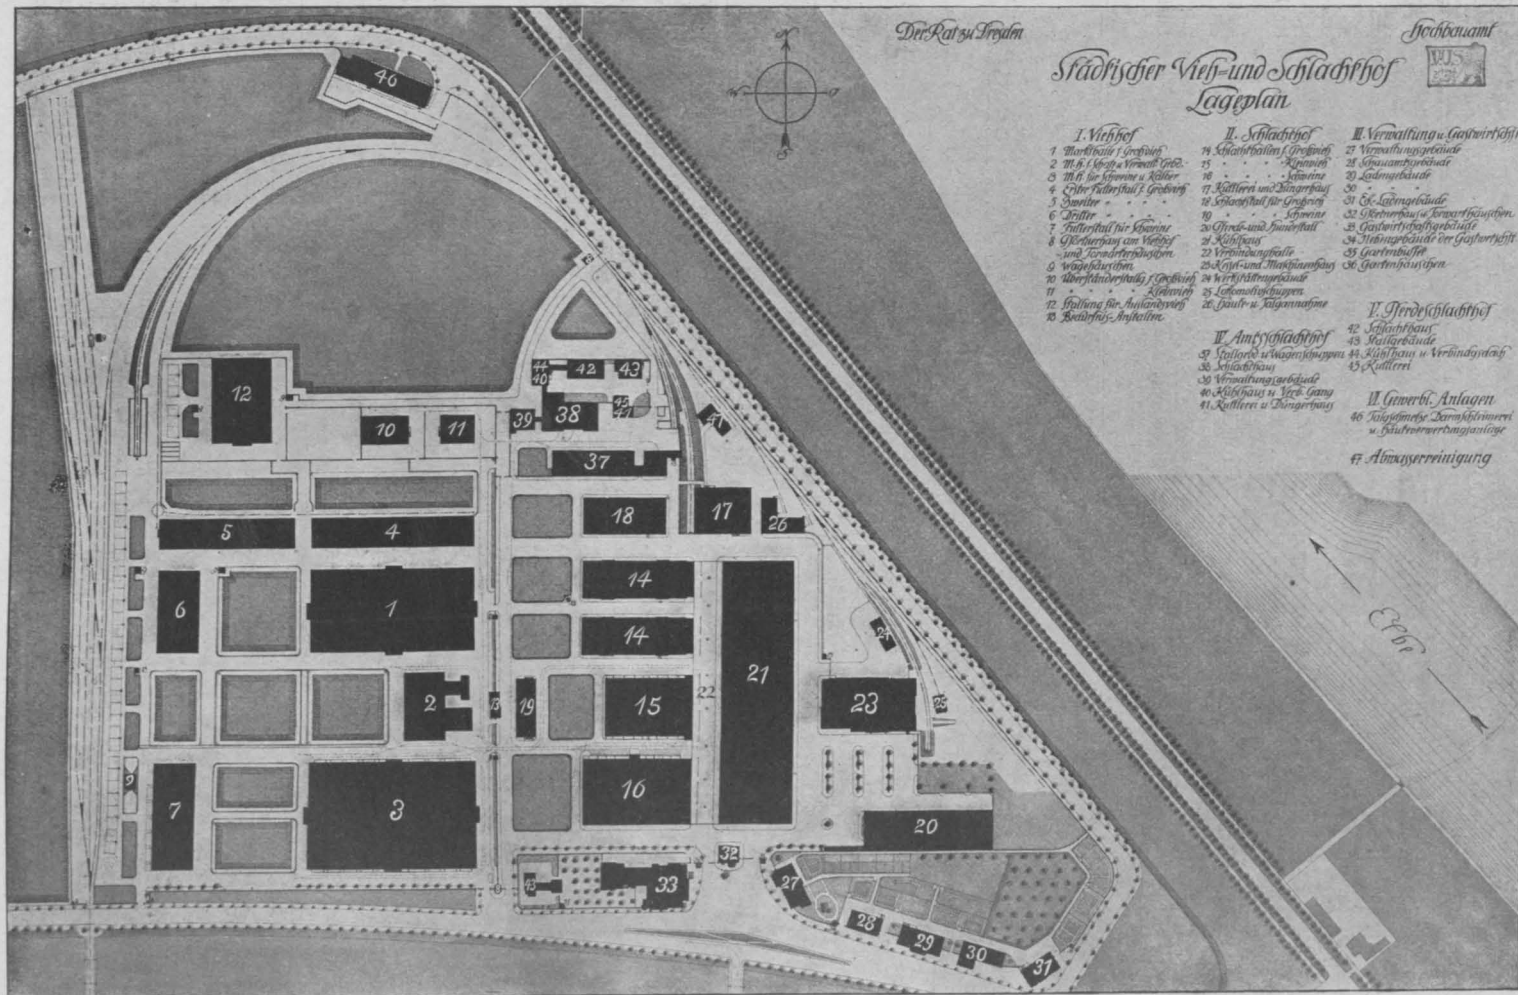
Dresdner Vieh- und Schlachthof, Lageplan.
